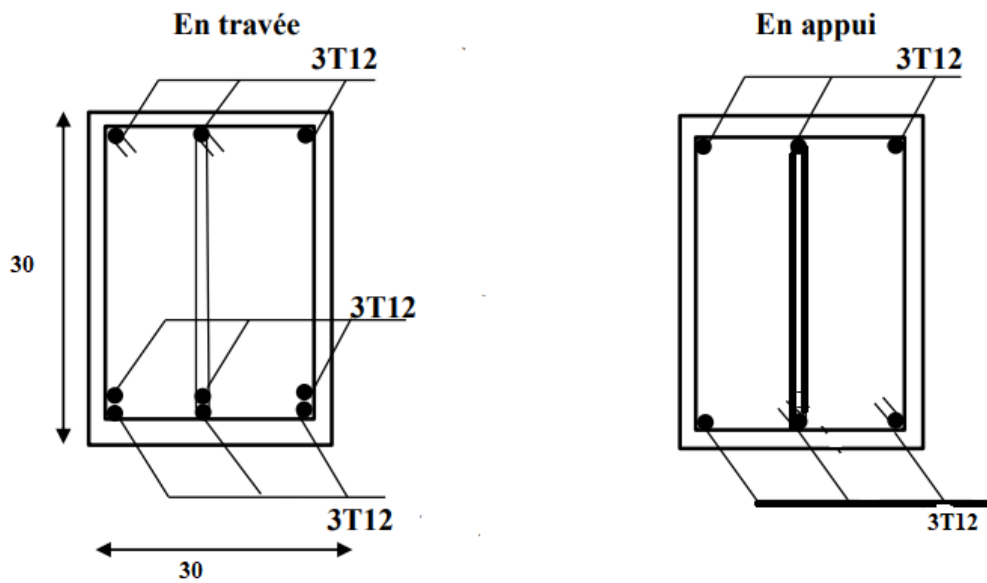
coupe de Ferrailage de la poutre palier.
